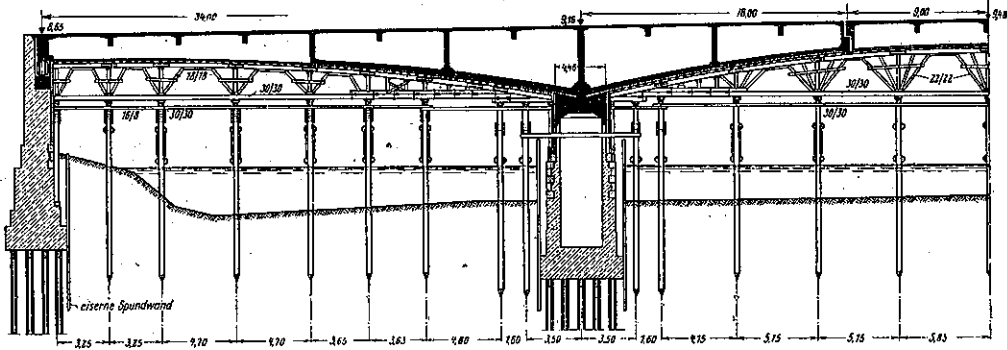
Pisa 近郊 Arno 河橋 (桁端部)
